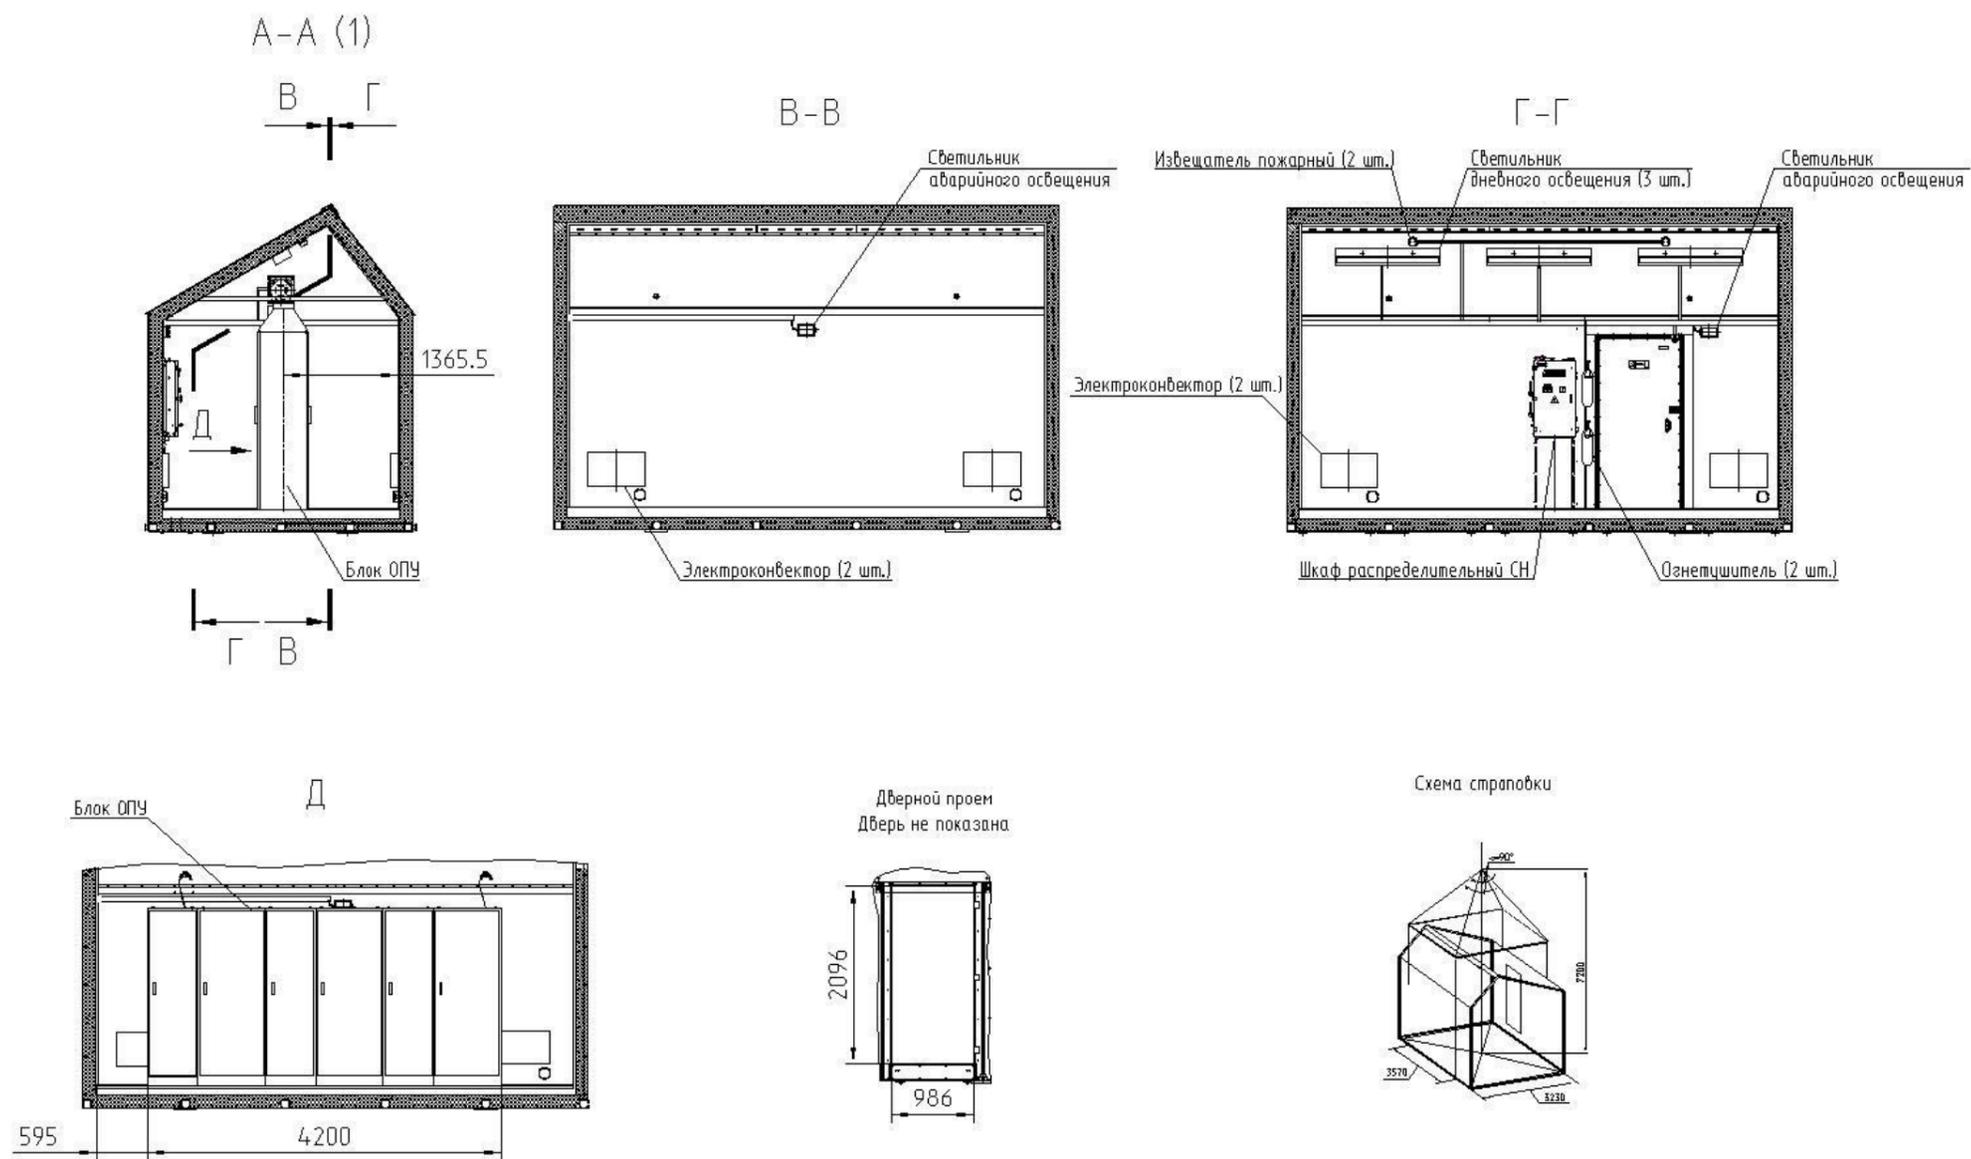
Габаритный чертеж модуля ОПУ типоразмером 6 м
